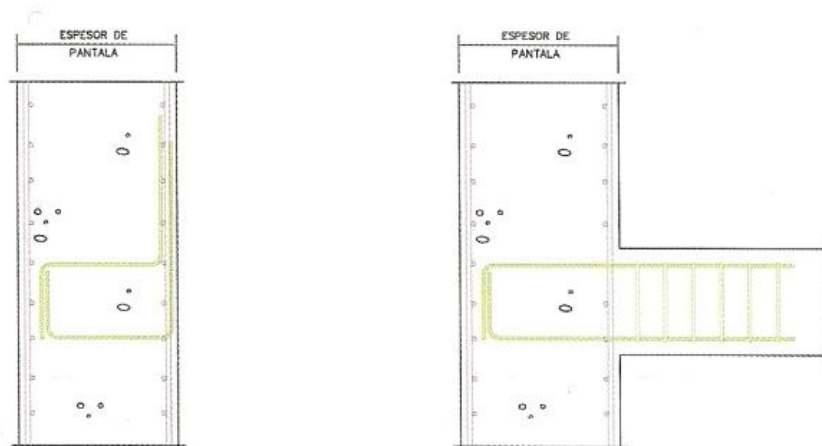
Ligação laje-muro com esperas dobradas (Calavera, 1999)
